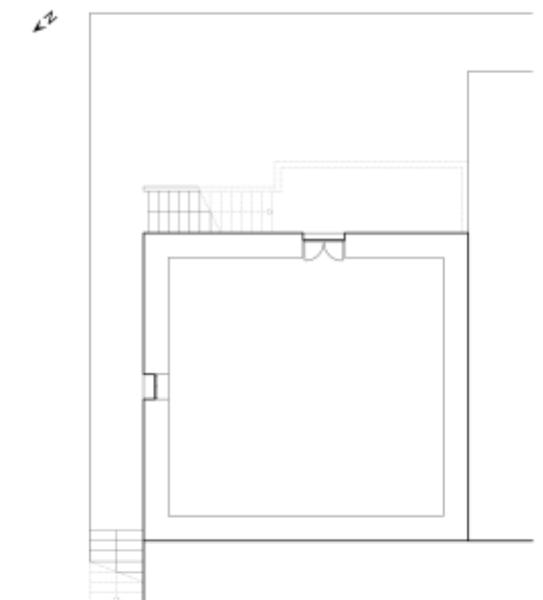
Planta do Piso 0 da casa P1, com loja. (Ilustração nossa, 2021)
